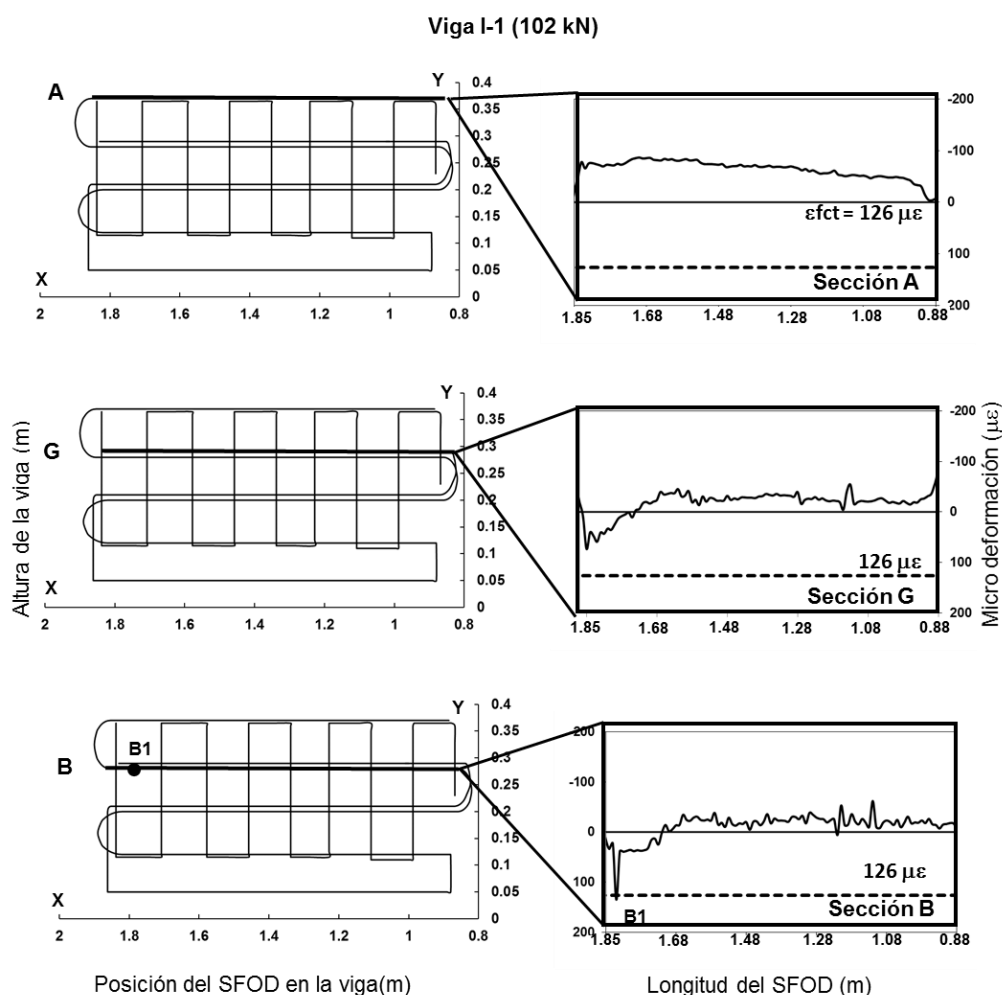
Deformaciones en las secciones A, G y B del SFOD1 en la viga I-1(102 kN).
